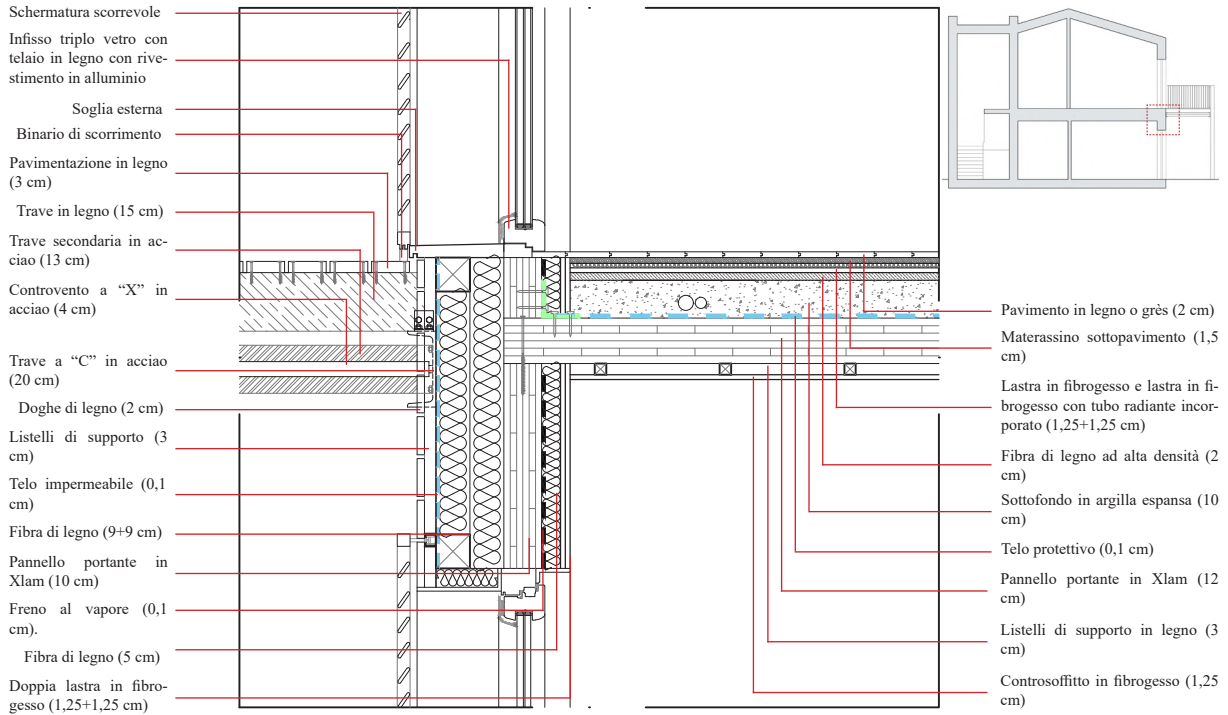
Nodo solaio interpiano - parete perimetrale - balconata esterna (scala 1:20)
